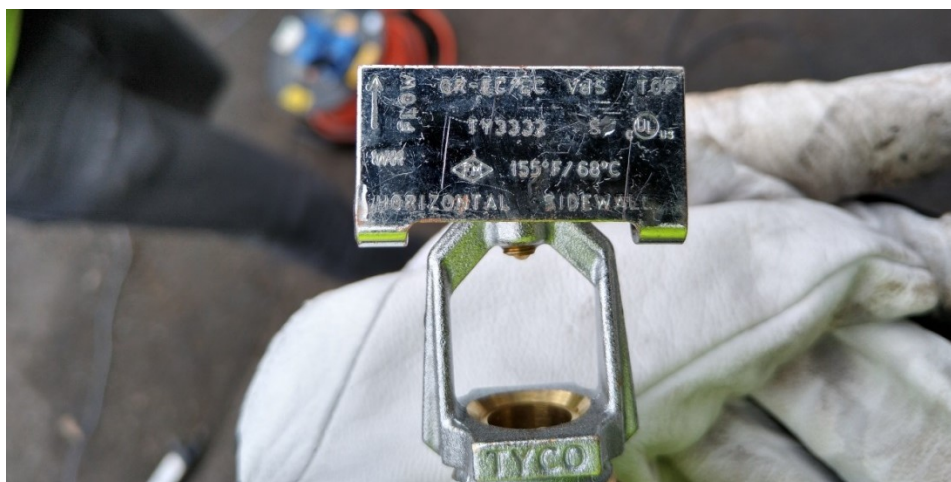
Detailansicht Side-Wall-Sprinkler
